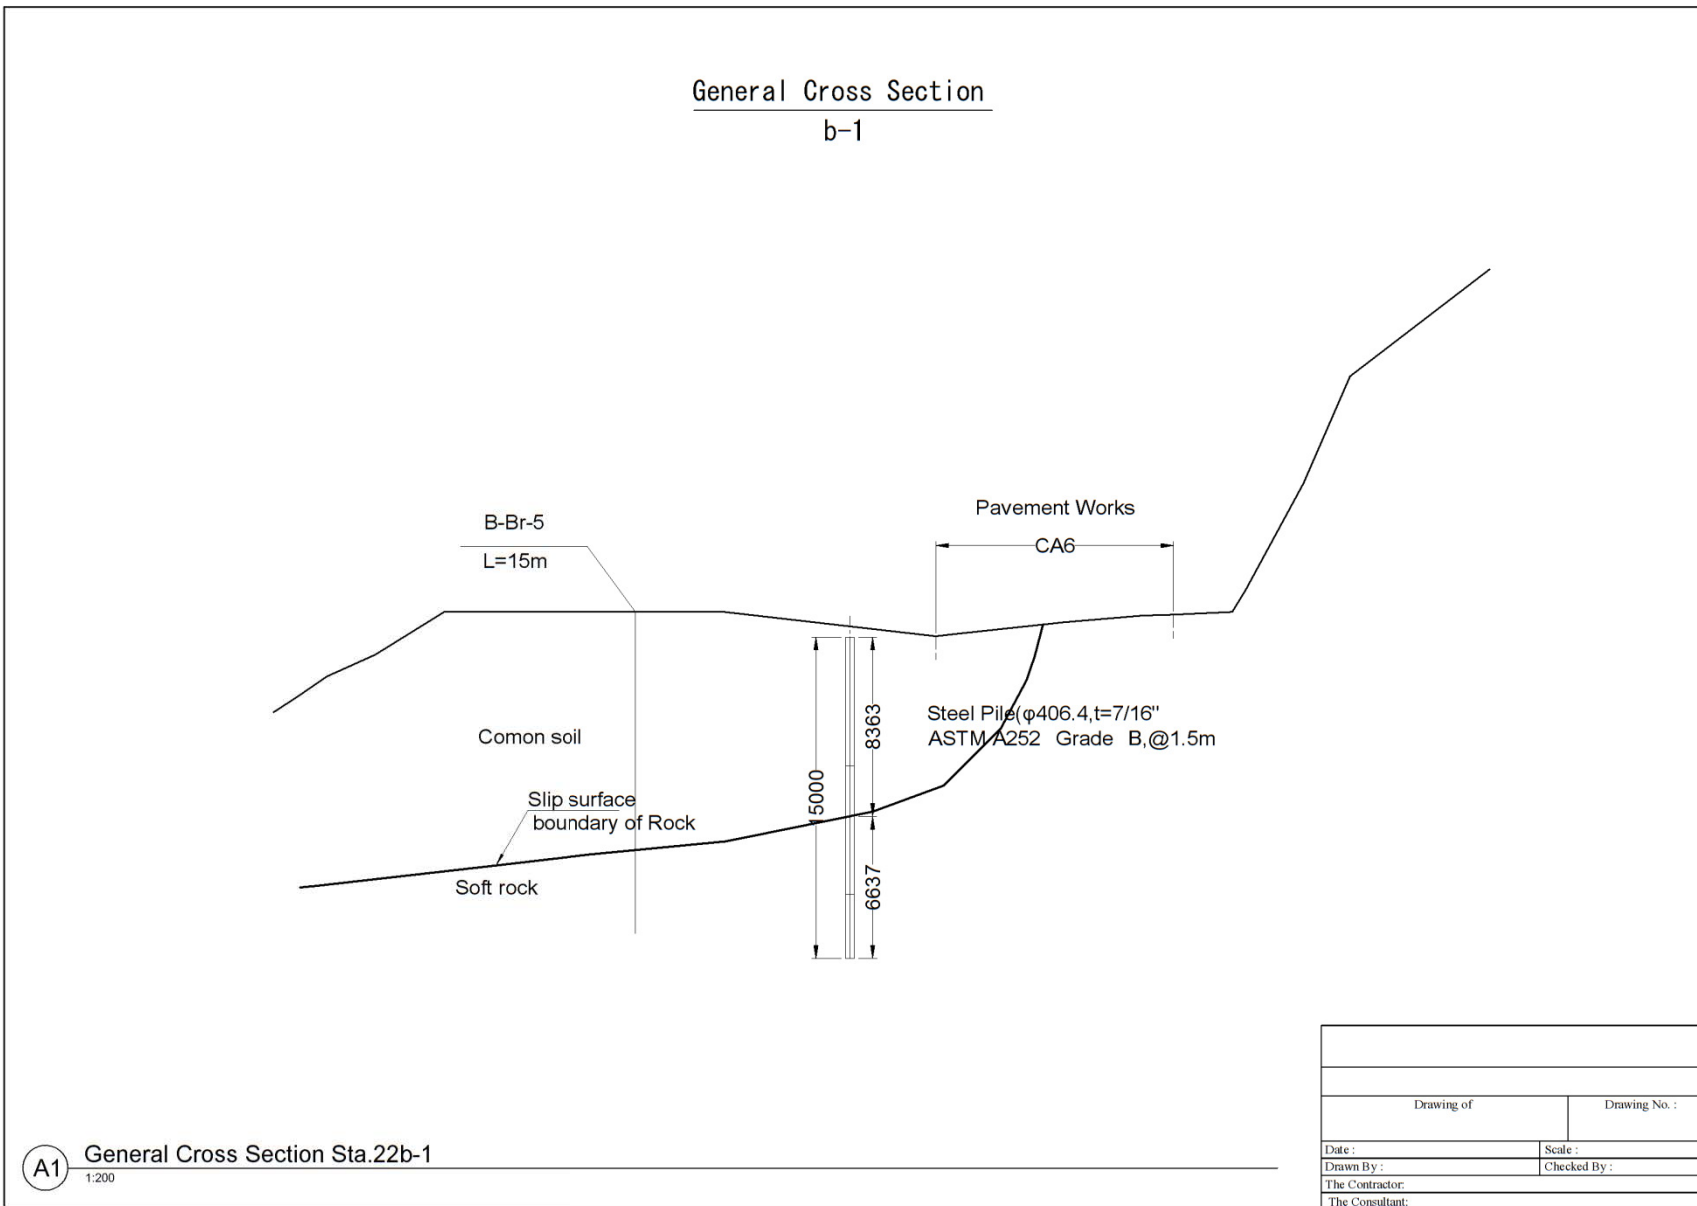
Sta. 22 b-1 平面図 (Non-Scale)
